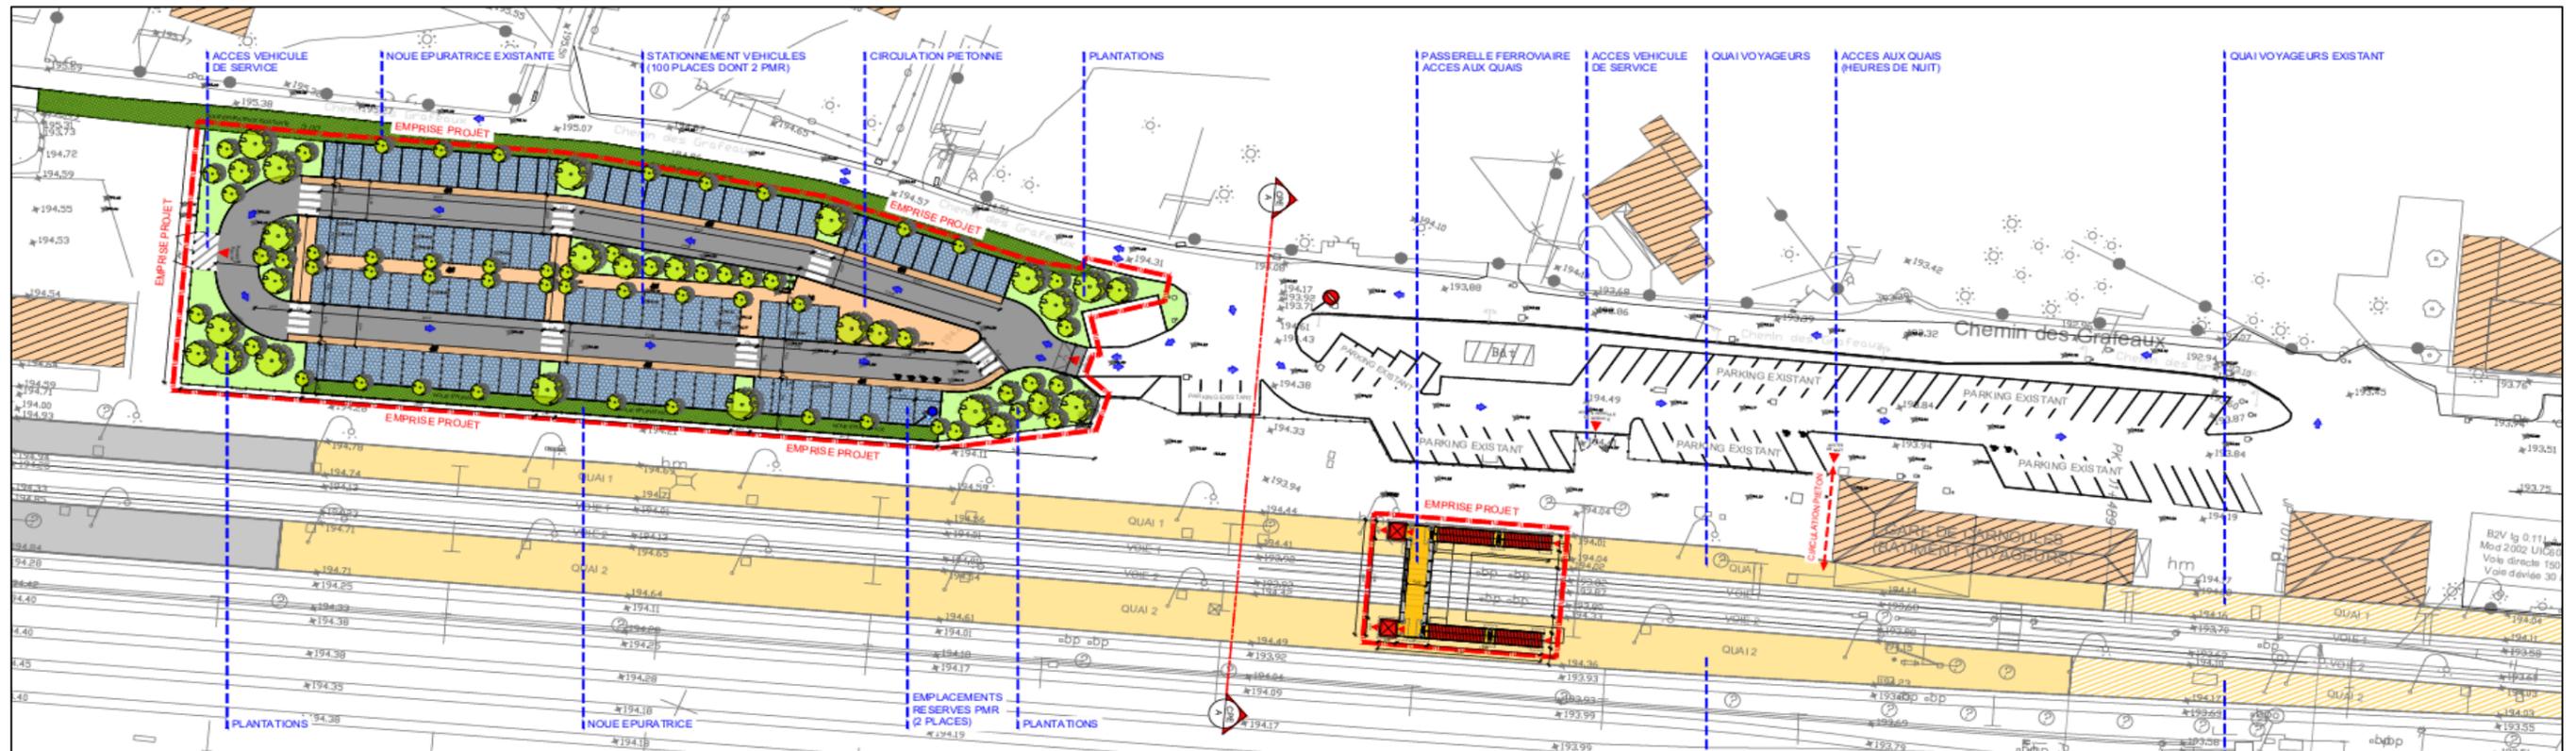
Carnoules - Plan d'aménagement du site (AREP, 2021)
